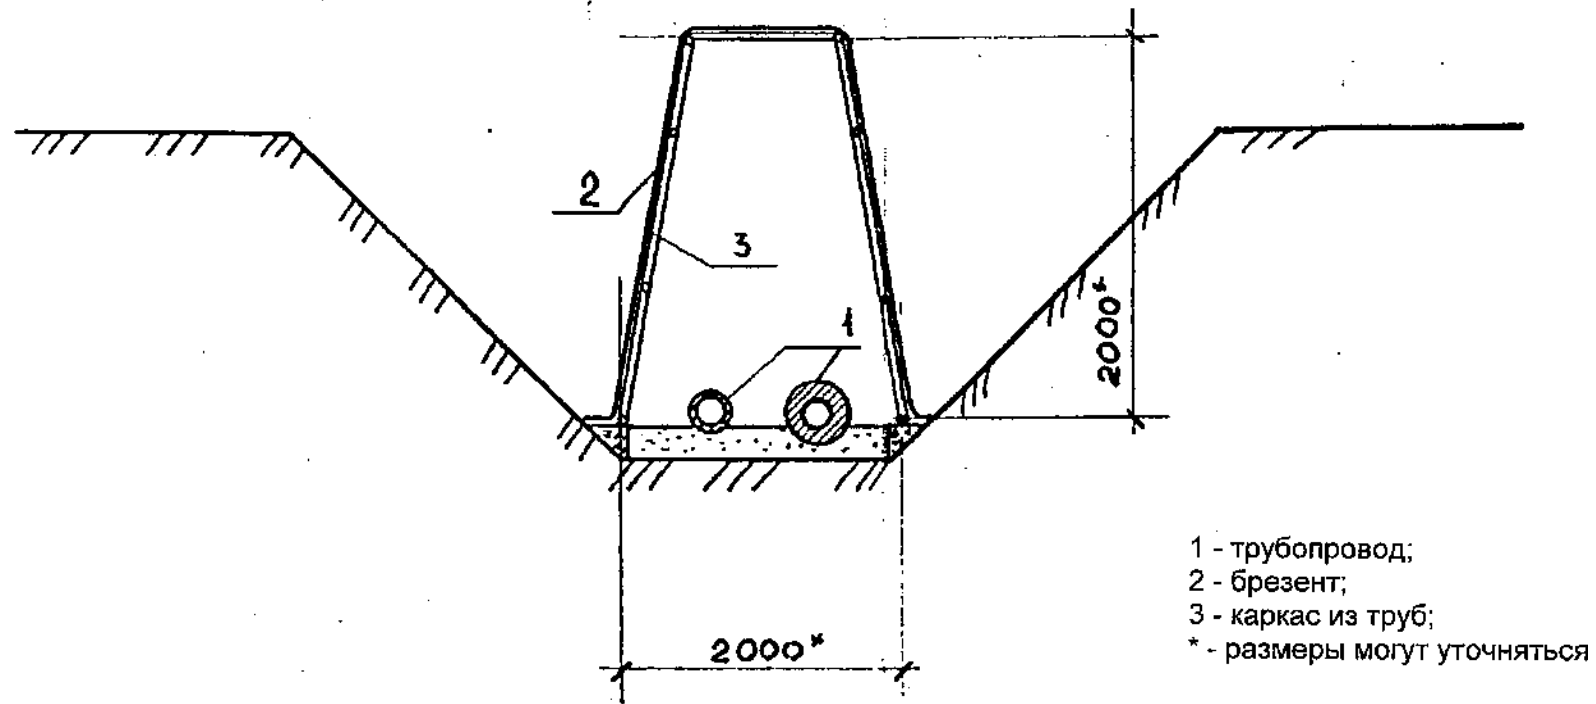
Тепляр для производства сварочных работ
